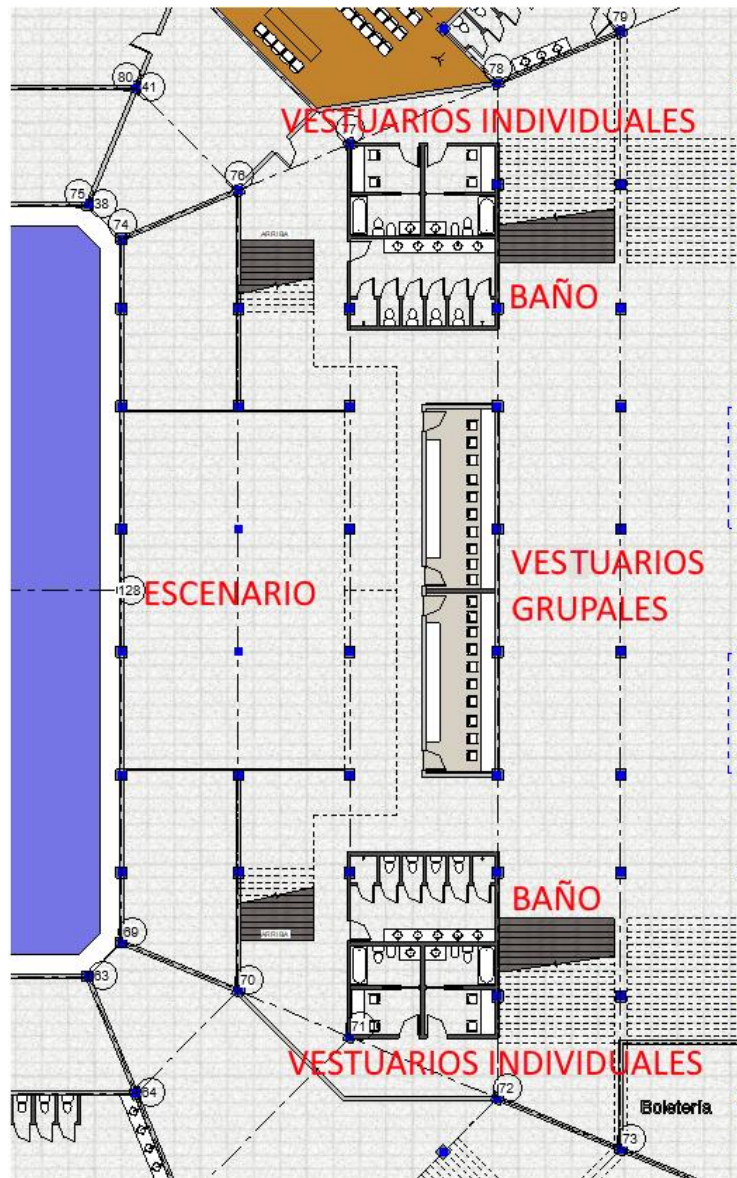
Vista en planta del sector este. Fuente: elaboración propia.
